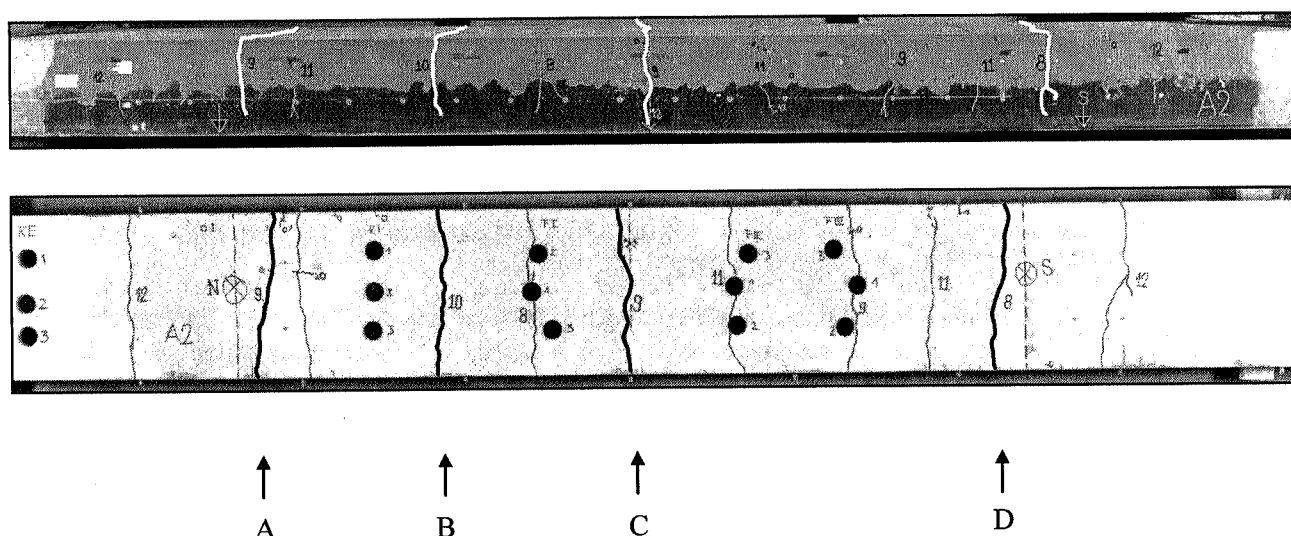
Vue latérale et en plan de la poutre testée et des fissures choisies
